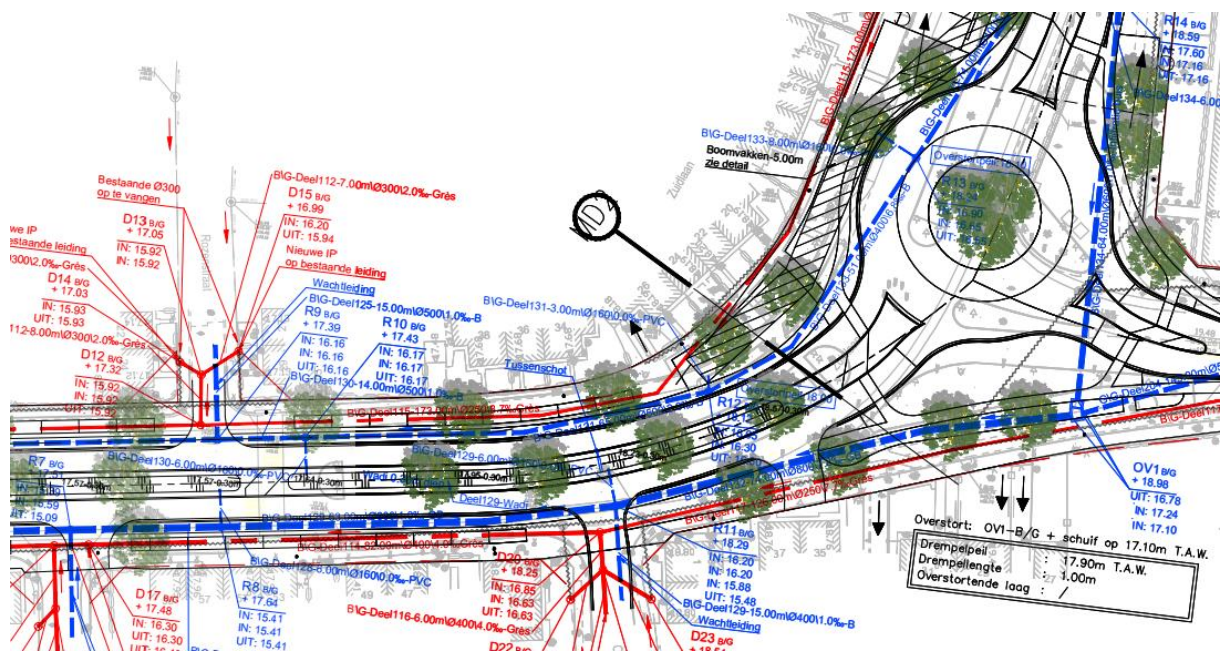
Uitsnede uit ontwerpplan, westelijk uiteinde plangebied (bron: opdrachtgever).
